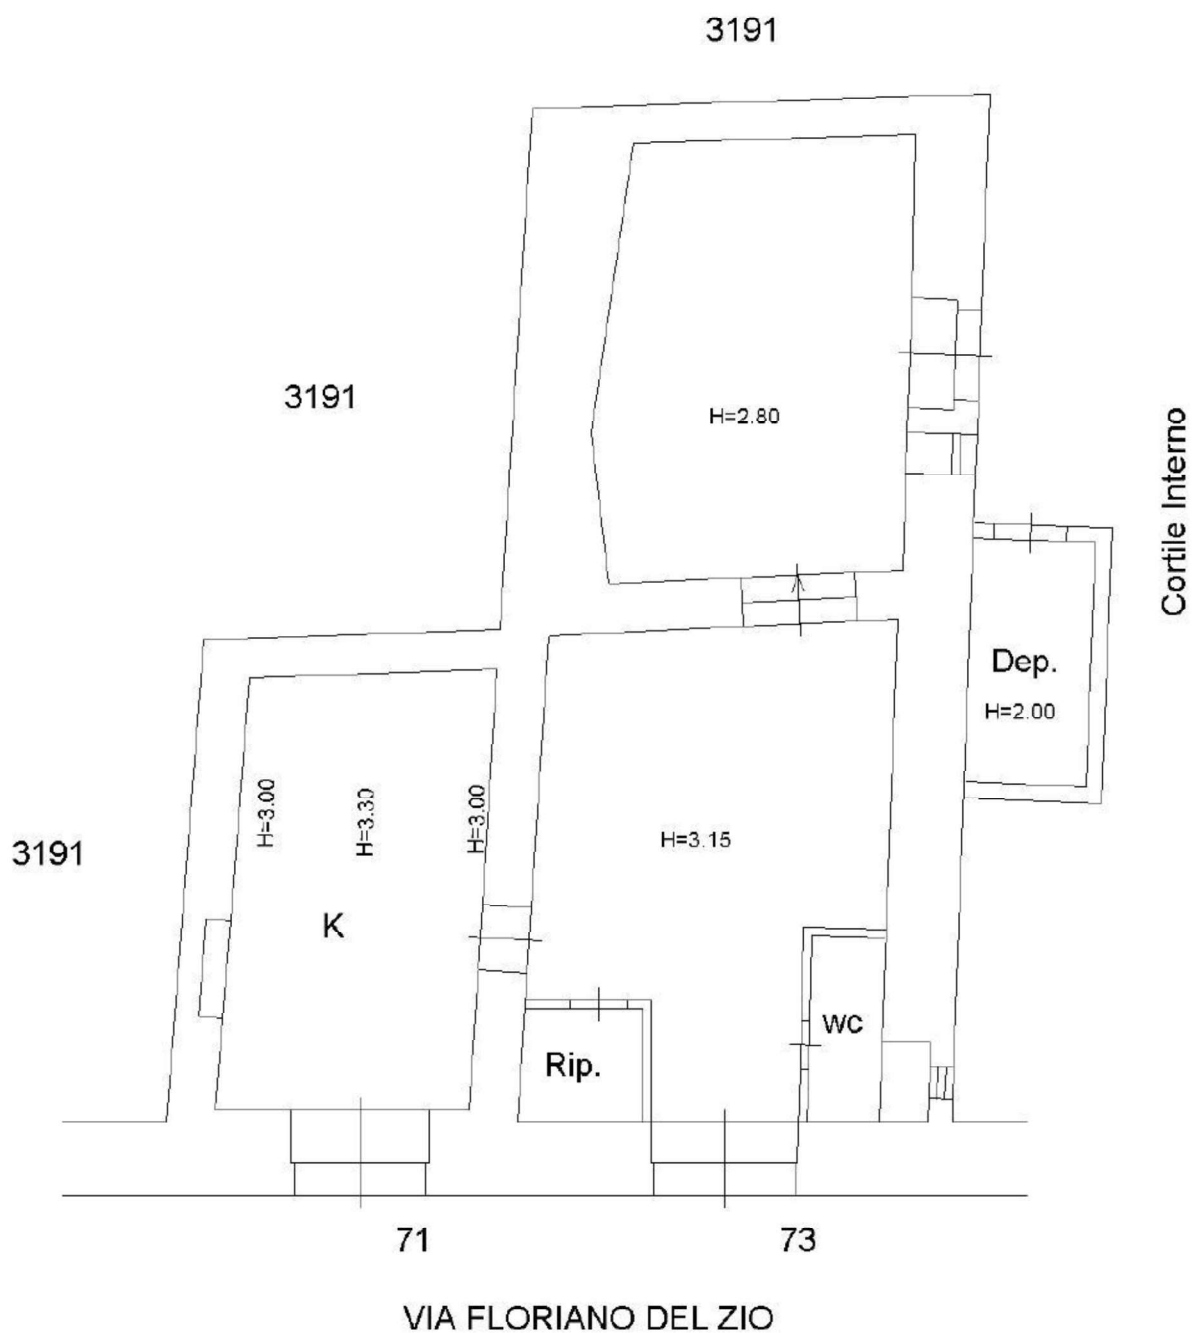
Planimetria Catastale Abitazione Piano Terra.
